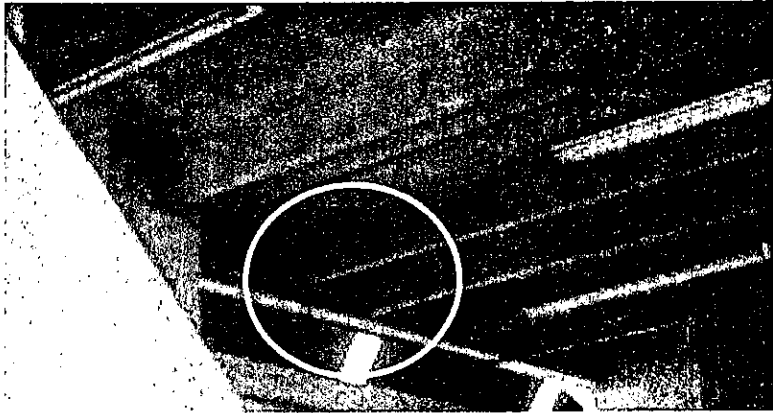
APOYOS PERIMETRALES DE LAS TRABES DOBLES TEE
